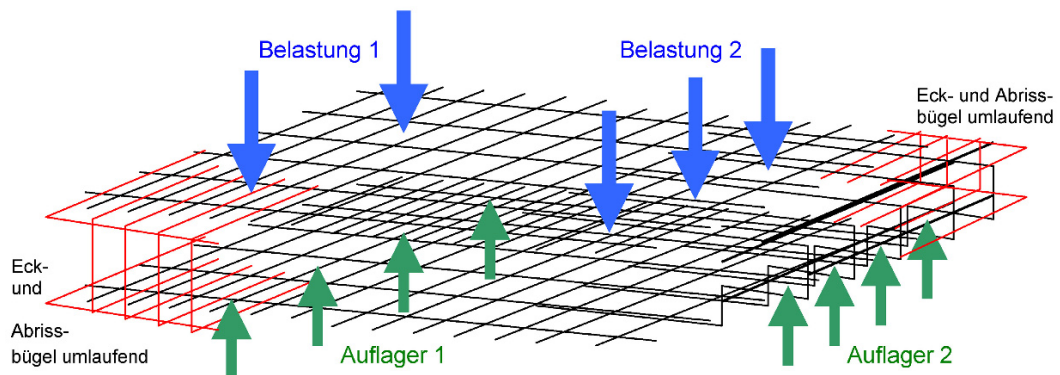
Unterschied von statischen (schwarz) und konstruktiven (rot) Betonstahlformen im Geflecht
